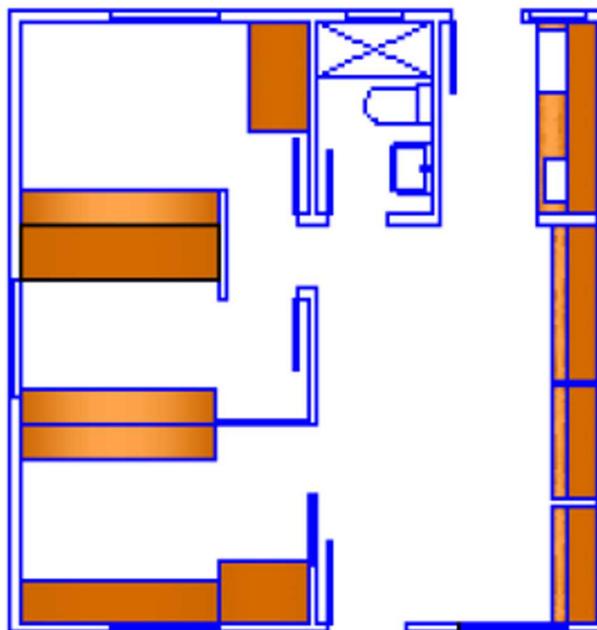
Propuesta Planta Arquitectónica implementado mobiliario plegable
